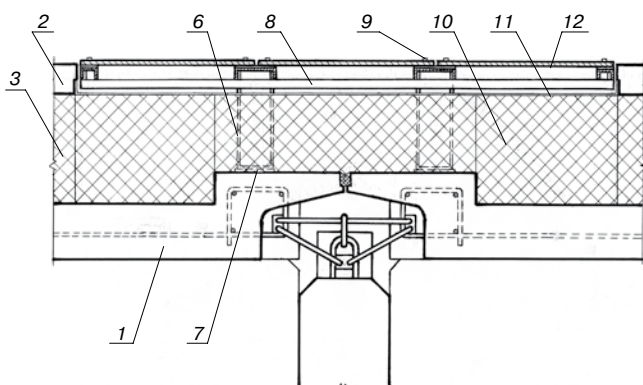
Участки наружных панелей у боковых торцов после монтажа навесного фасада: 1—5 (см. рис. 1); 6 — кронштейн; 7 — прокладка термоизолирующая; 8 — решетка из профилей; 9 — клямер; 10 — утеплитель; 11 — гидроветрозащитная паропроницаемая мембрана; 12 — облицовочная плита
